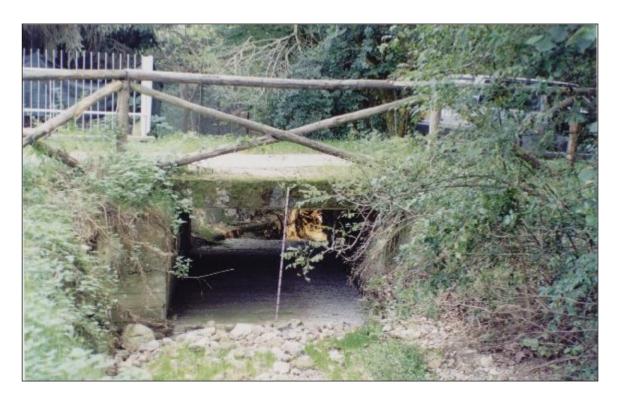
Rio Verdeis attraversamento – opera n° 6
